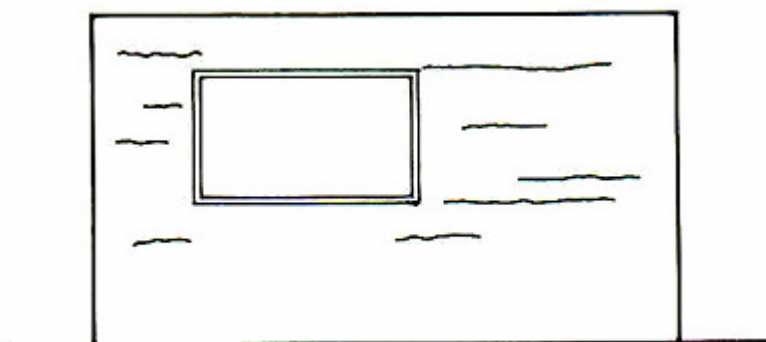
fissuras horizontais no revestimento provocadas pela expansão da argamassa de assentamento (THOMAZ, 1989, p. 120)
